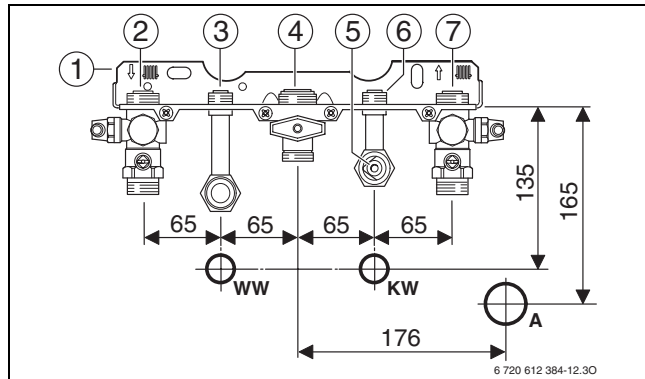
Aufputzanschlüsse mit Wandabstand 60 mm
